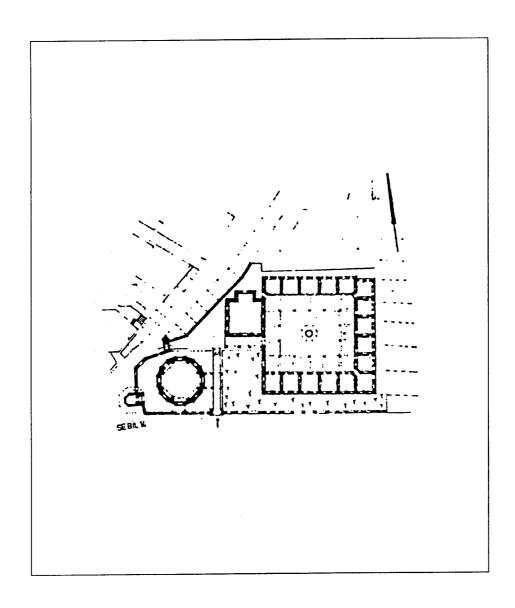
مسقط أفقي لمسجد الوالده الجديد (يني جامع) في إستانبول (عن : جودوين) .
